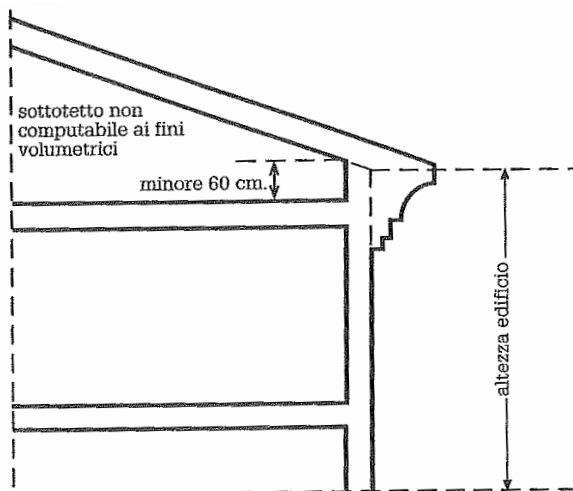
Edificio con dislivello inferiore a 60 cm e gronda sotto l'intradosso del solaio dell'ultimo piano abitabile
